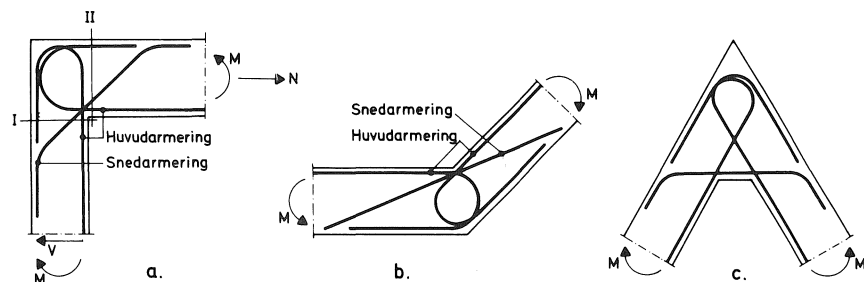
Utformning av armering i rätvinkligt, trubbvinkligt och spetsvinkligt ramhörn belastat med positivt moment.
